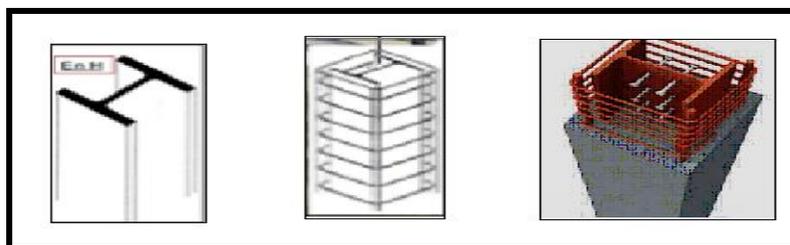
poteaux à section en H. laminée enrobée de béton.
